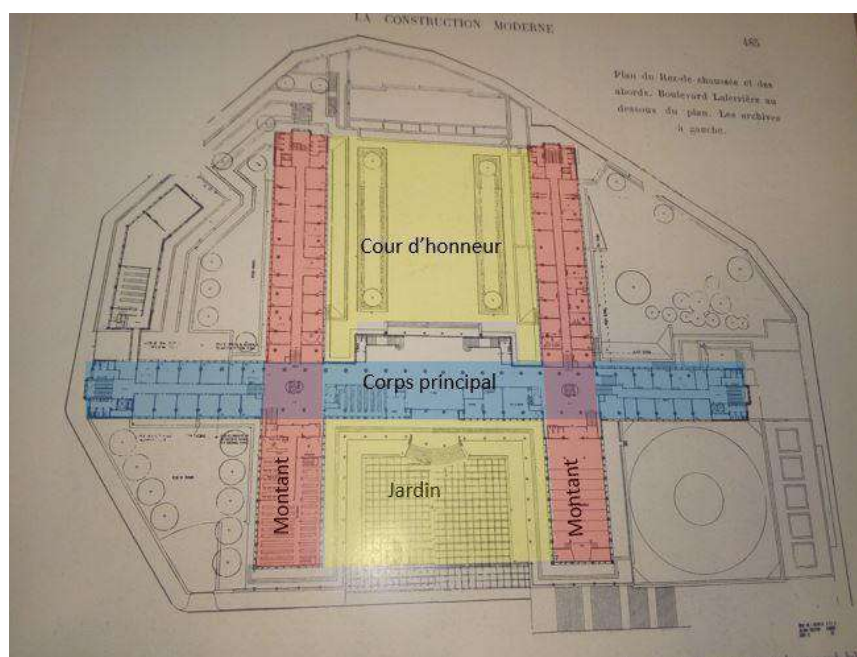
Plan du Palais du Gouvernement Général – Traité
